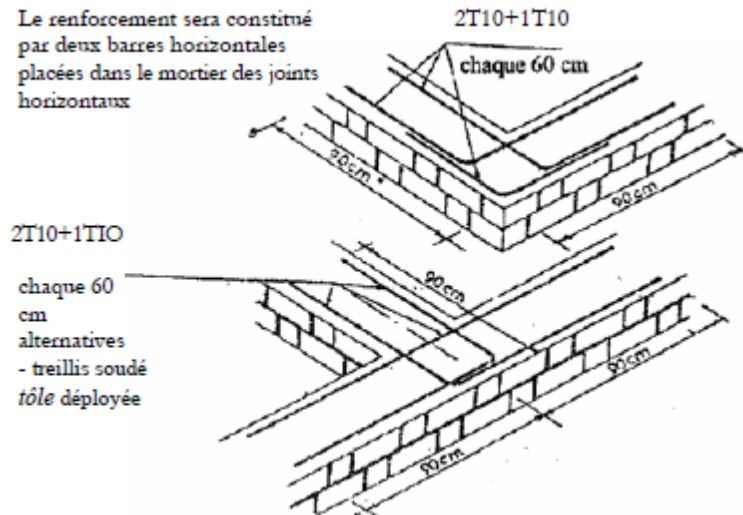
Armatures dans les assises à l'endroit du croisement des murs
